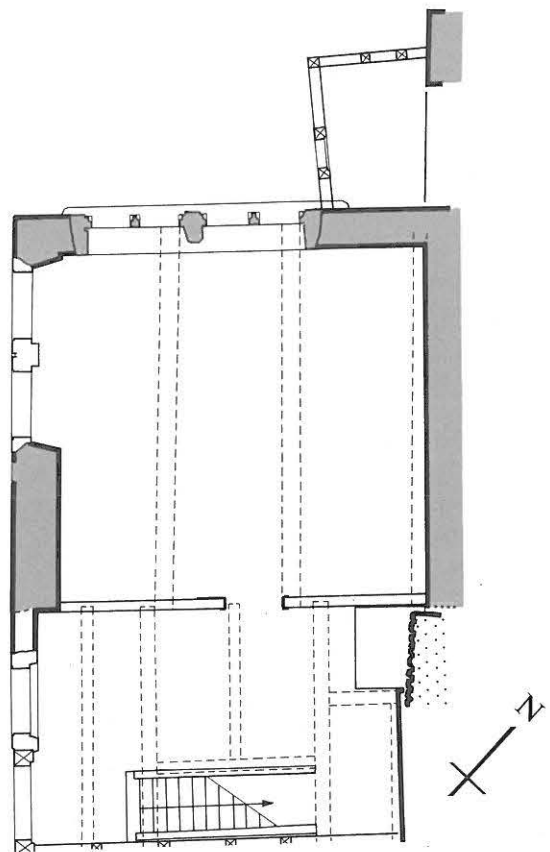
Laupen, Kreuzplatz 1. Grundriss Erdgeschoss. M. 1:100.
